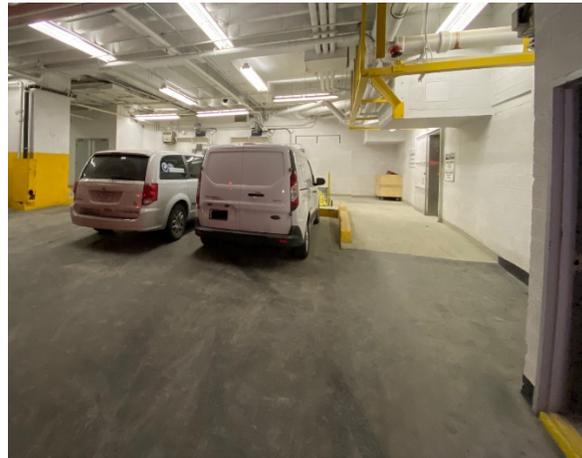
Photo prise depuis la porte du quai de chargement avec vue sur l'intérieur de la zone du quai de chargement
